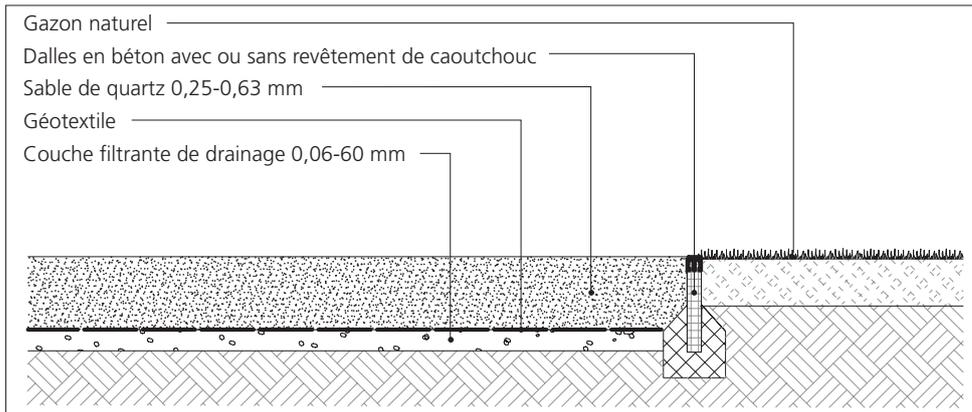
Schéma en coupe d'une bordure avec dalles en béton
